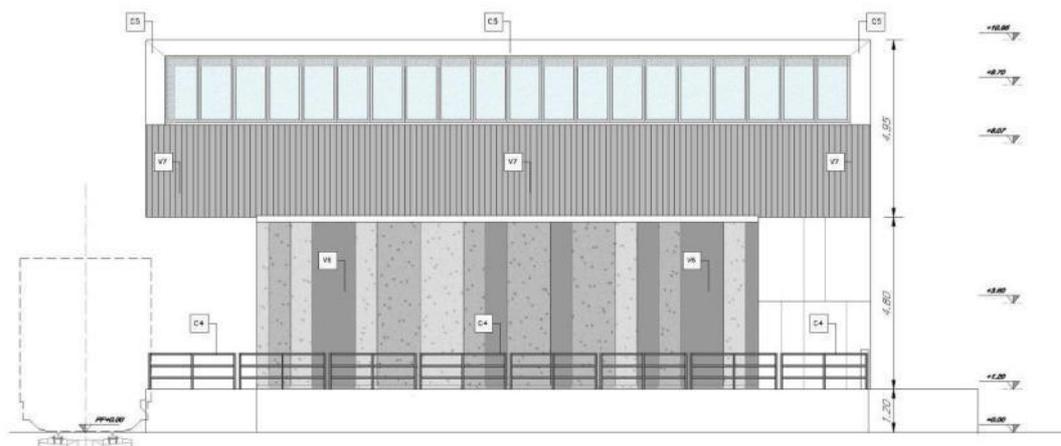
Prospetto Ribalta Ferro-Gomma
